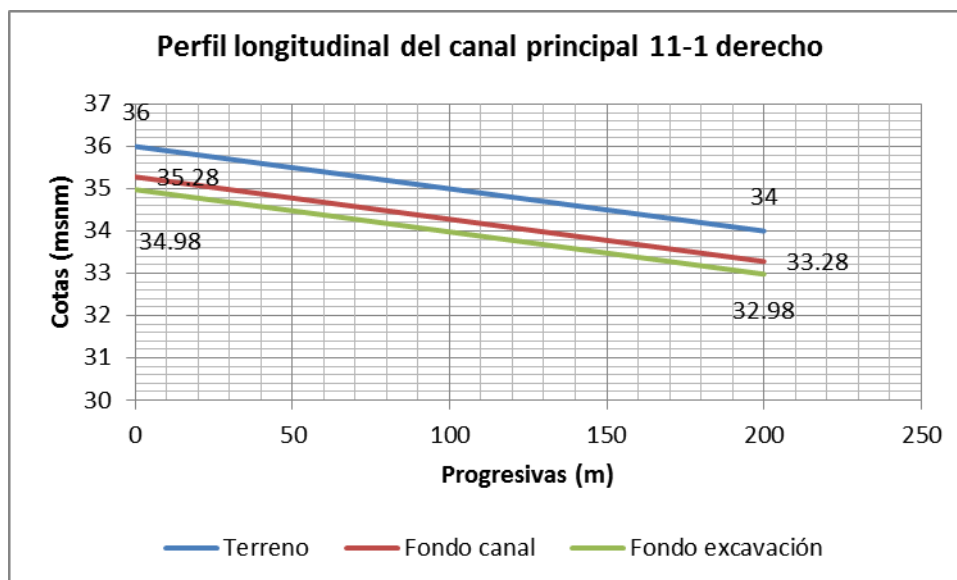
Perfil longitudinal de canal principal 11-1 derecho (Gómez, M. 2022).
